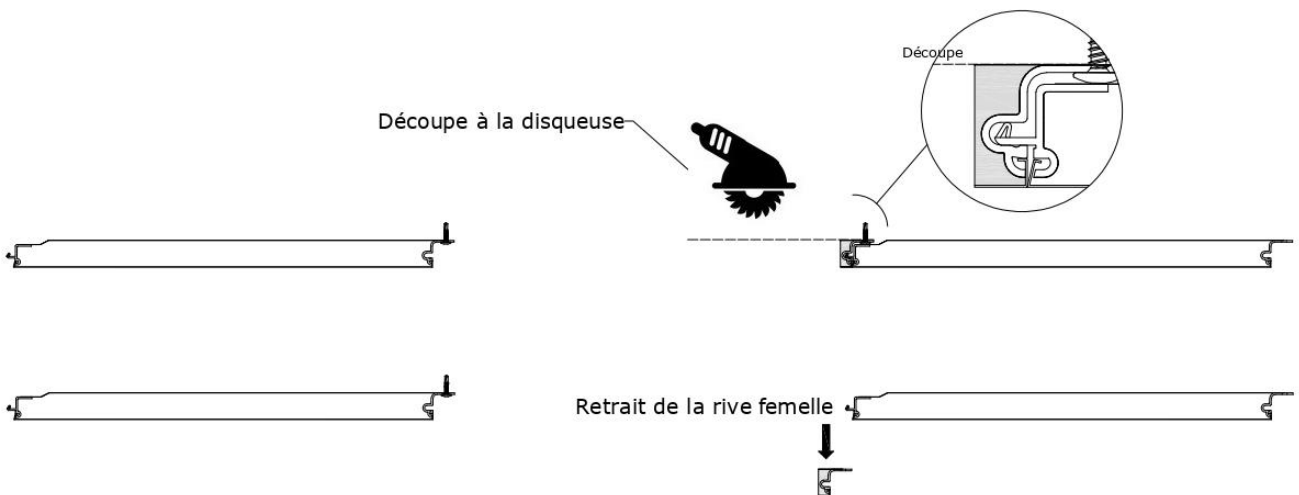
Raccord horizontal sans profil – Panneau à recouvrement
